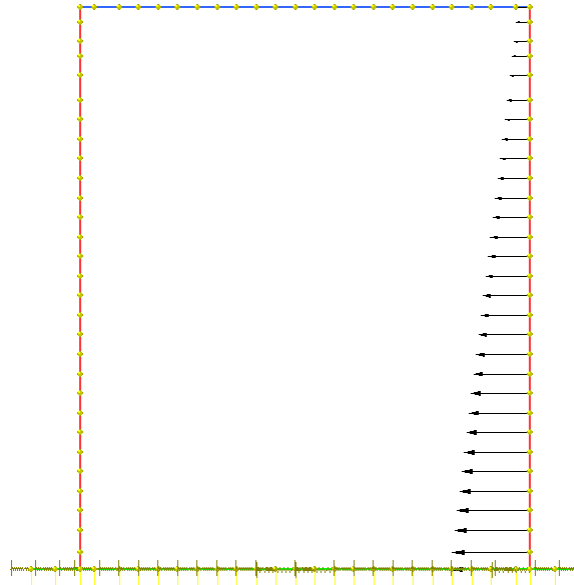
SPINTA ATTIVA DELLE TERRE SUL PIEDRITTO DESTRO (CDC 9)
